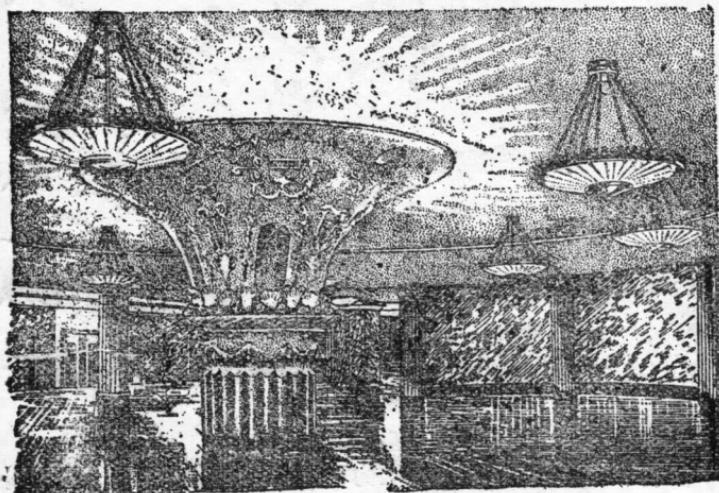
莫斯科地下鐵道車站的鋼筋混凝土柱子。
